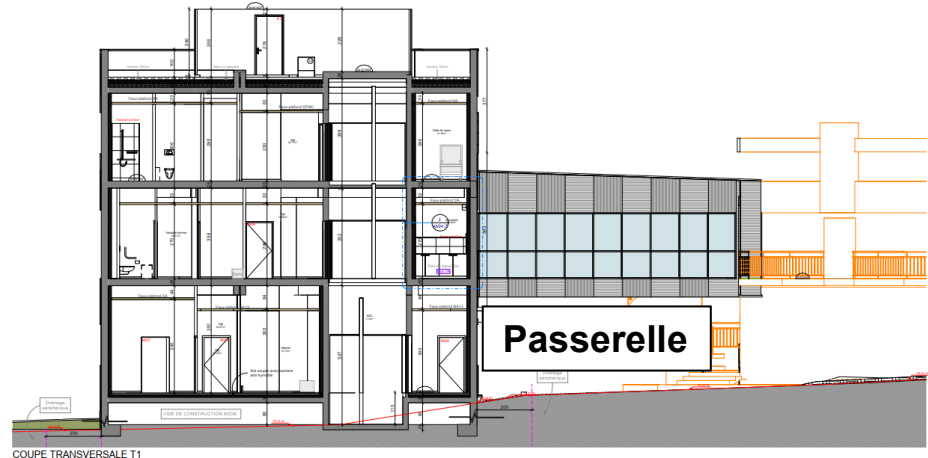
Extrait de la coupe transversale du projet (avec passerelle)
